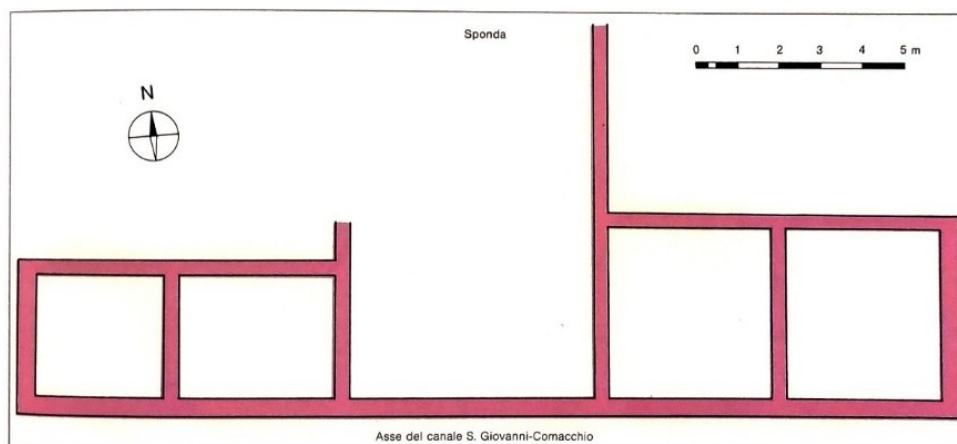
Planimetria dell'edificio di San Giovanni di Ostellato (Uggeri 1989).
